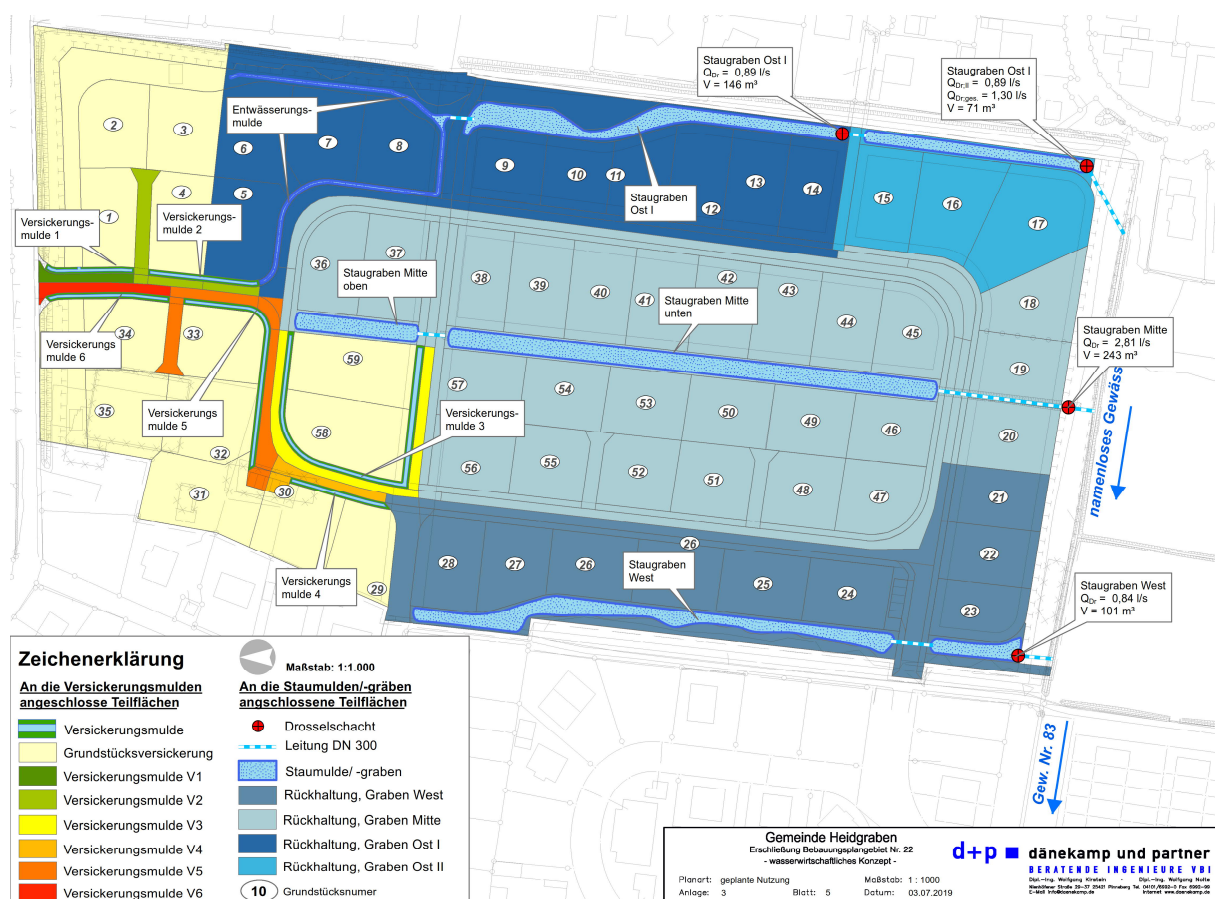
Wasserwirtschaftliches Konzept, Anlage 3 - Lageplan
